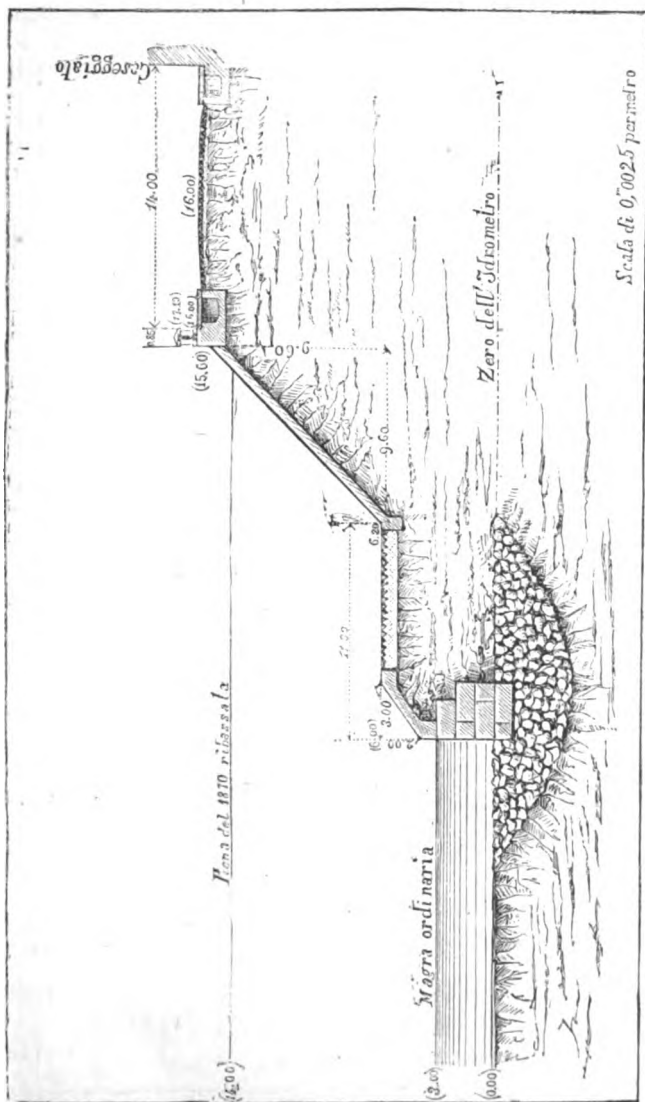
Tipo di scarpe murate ad alveo sistemato con i rettili.
